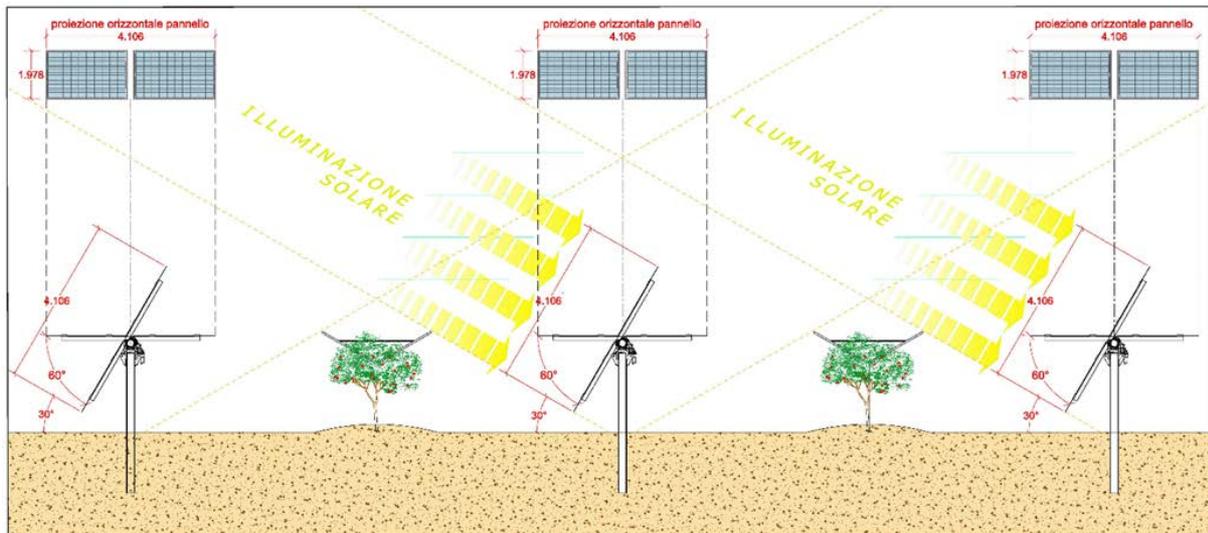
Sezione d'impianto con indicazione degli ingombri delle strutture ad inseguimento.
